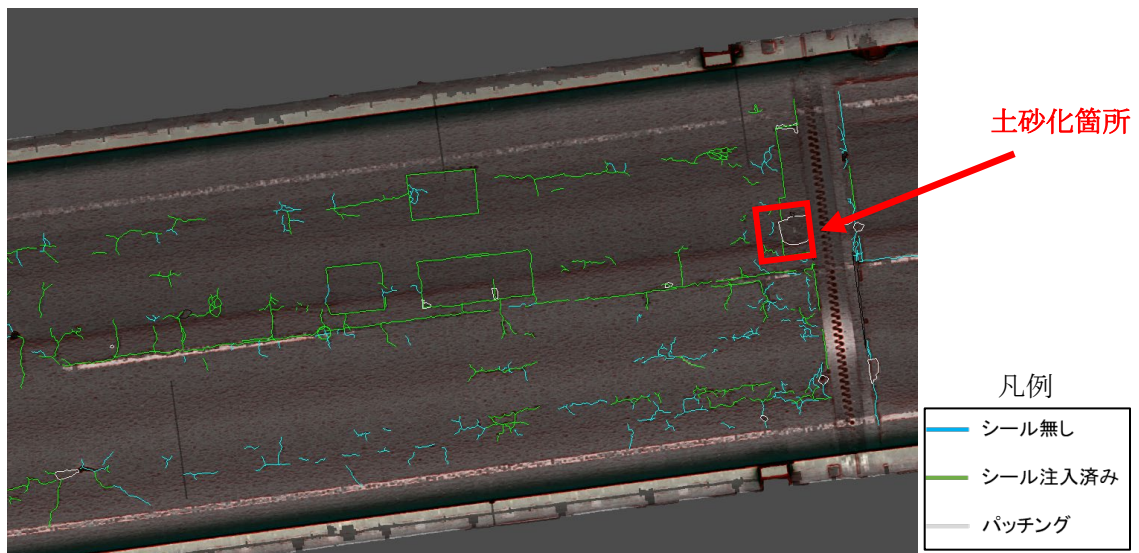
反射強度オルソ+ひび割れ
